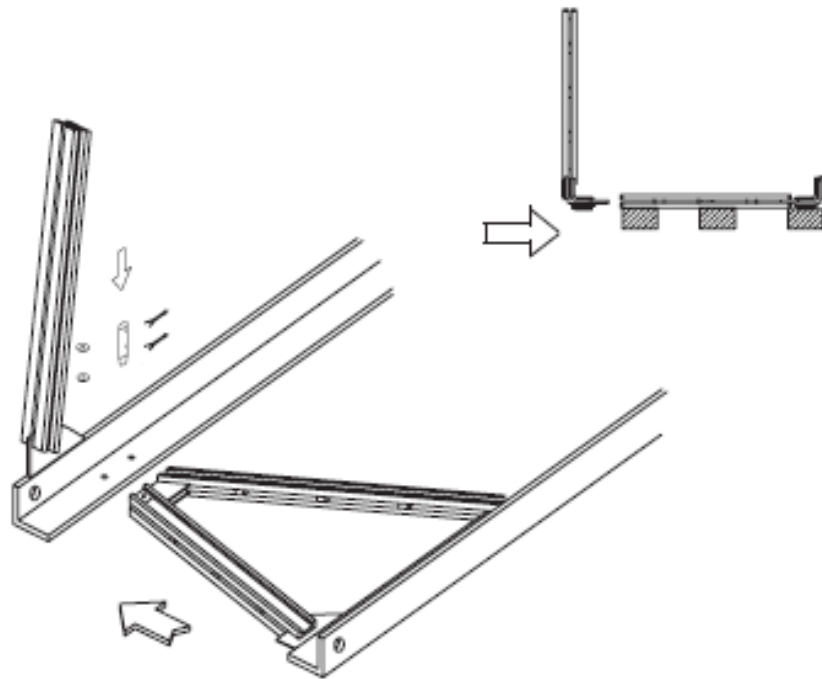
Detalle ensamblaje del tramo panelable
